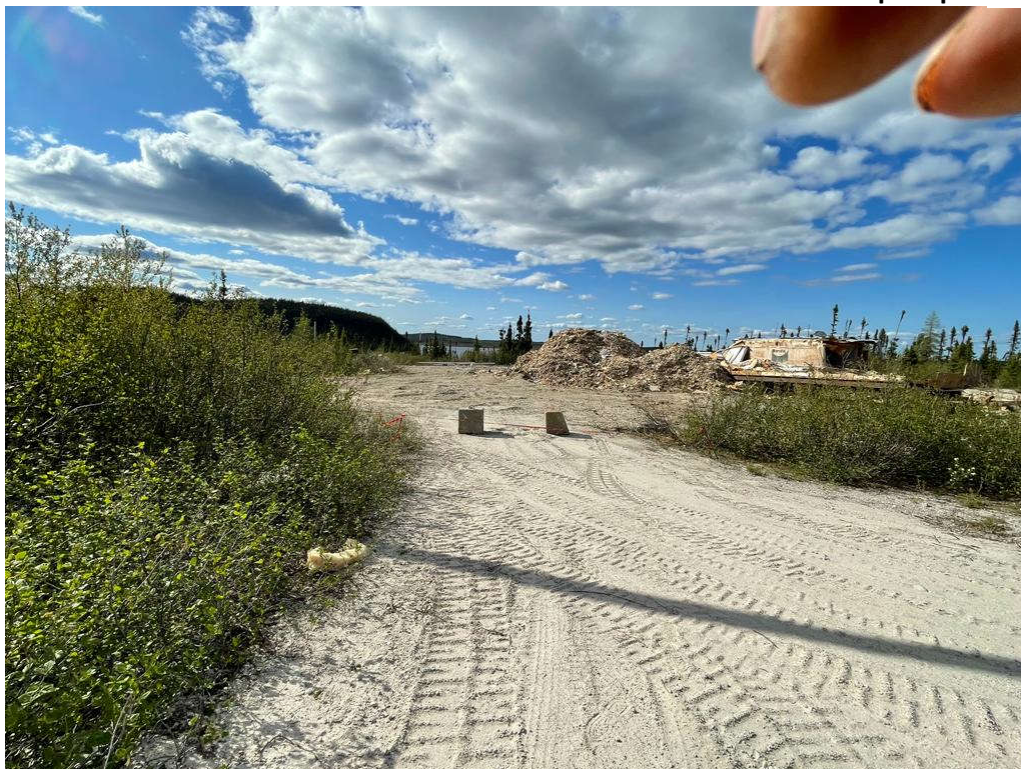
Vue des blocs installé à l'entrée secondaire du campement principal
